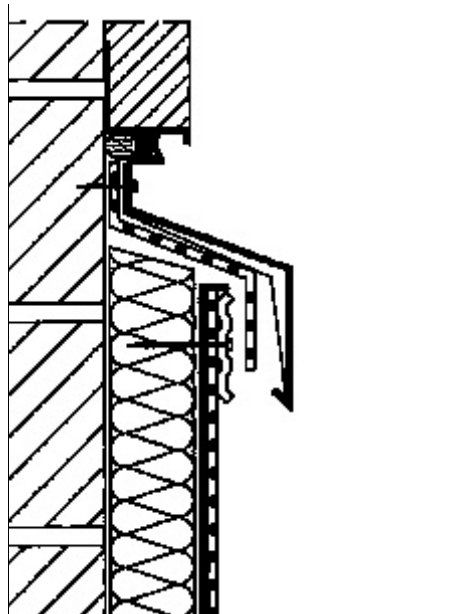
Starrer Wandanschluss, Deutsches Dachdeckerhandwerk Okt. 2008
